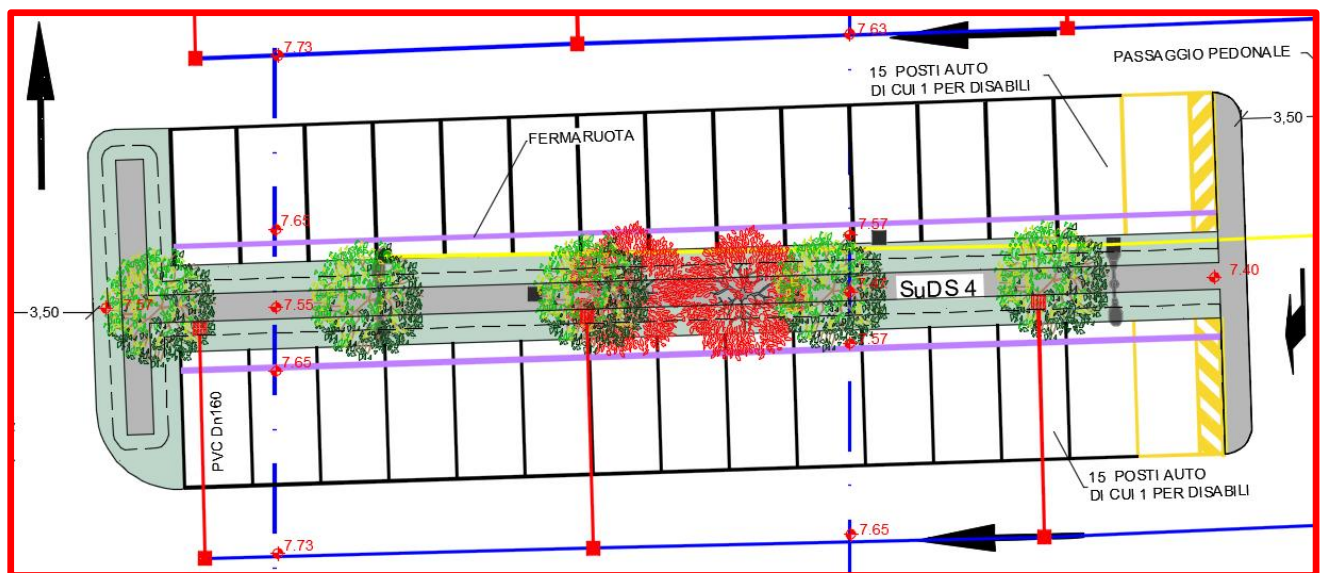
Estratto planimetrico dello stato di progetto – Area di bioritenzione n.4
